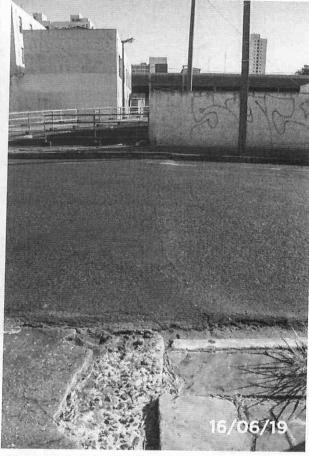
Vista da fissura no pavimento asfáltico no encontro 2.
